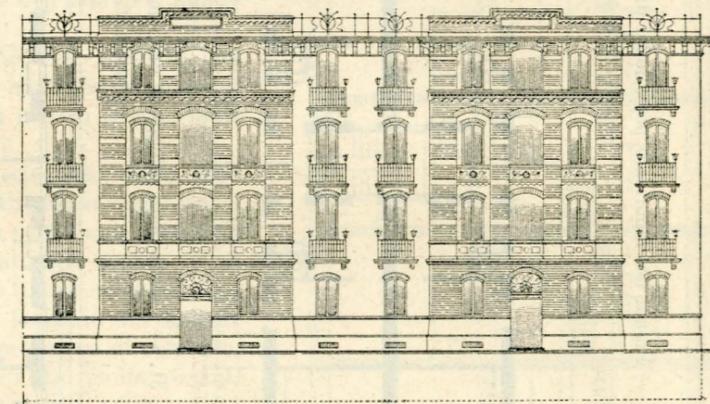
Prospetto geometrico di parte della facciata in via Colli.
